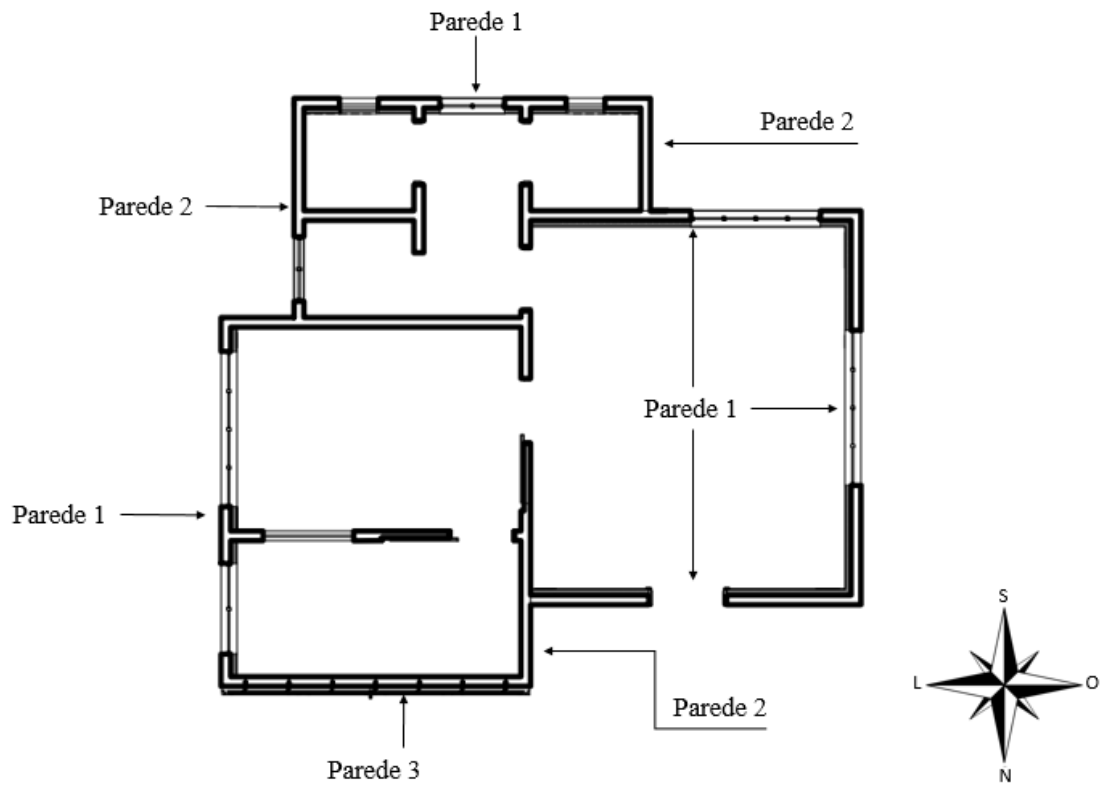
Posicionamento de cada tipo de parede na Planta Piloto Bioclimática. Fonte: do autor.
